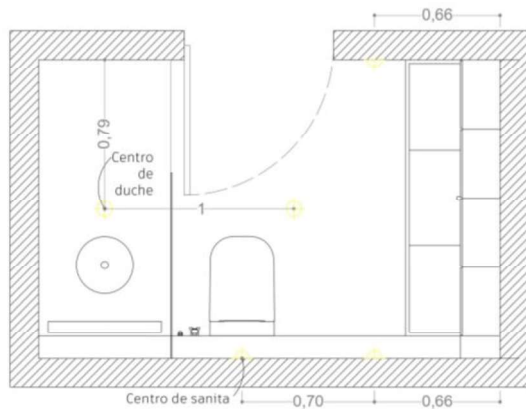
Planta de teto da instalação sanitária social. Fonte: Autor
